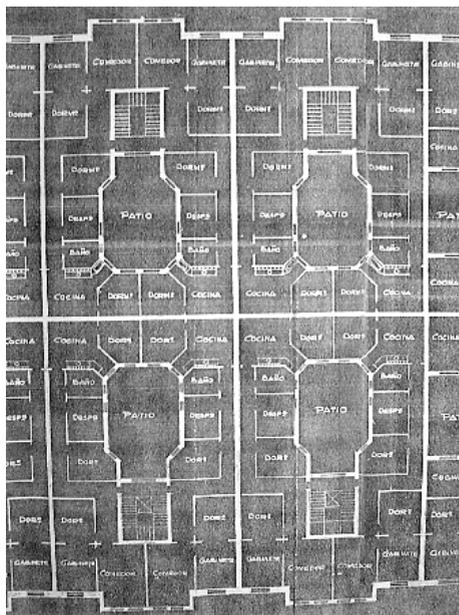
Archivo Foral de Bizkaia. Sección Fomento.1929 EE-39-48
